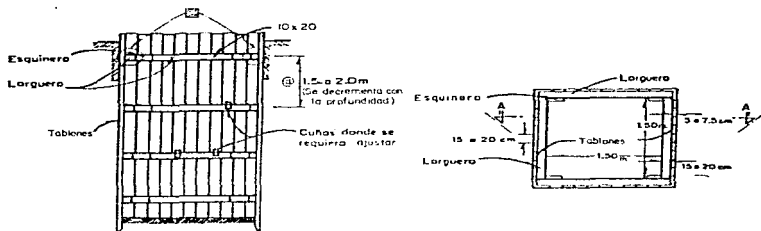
ADEMADO PARA UN POZO A CIELO ABIERTO
